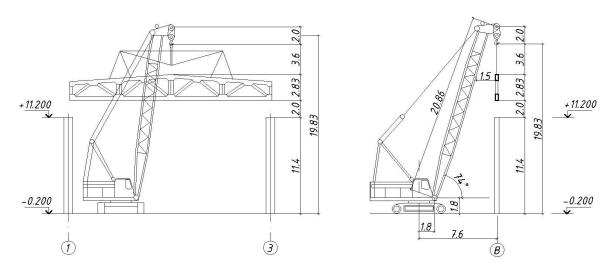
Схема расположения крана при монтаже железобетонных ферм
